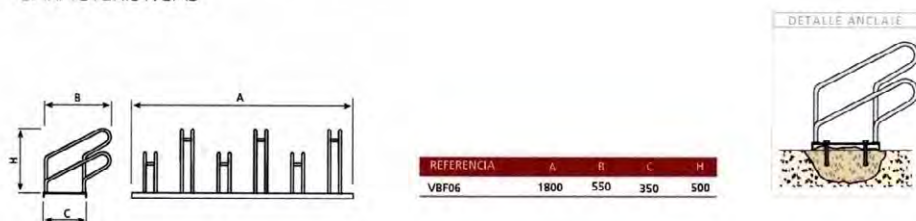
Dimensiones y detalle del anclaje del aparcabici elegido (fuente: www.benito.com).
